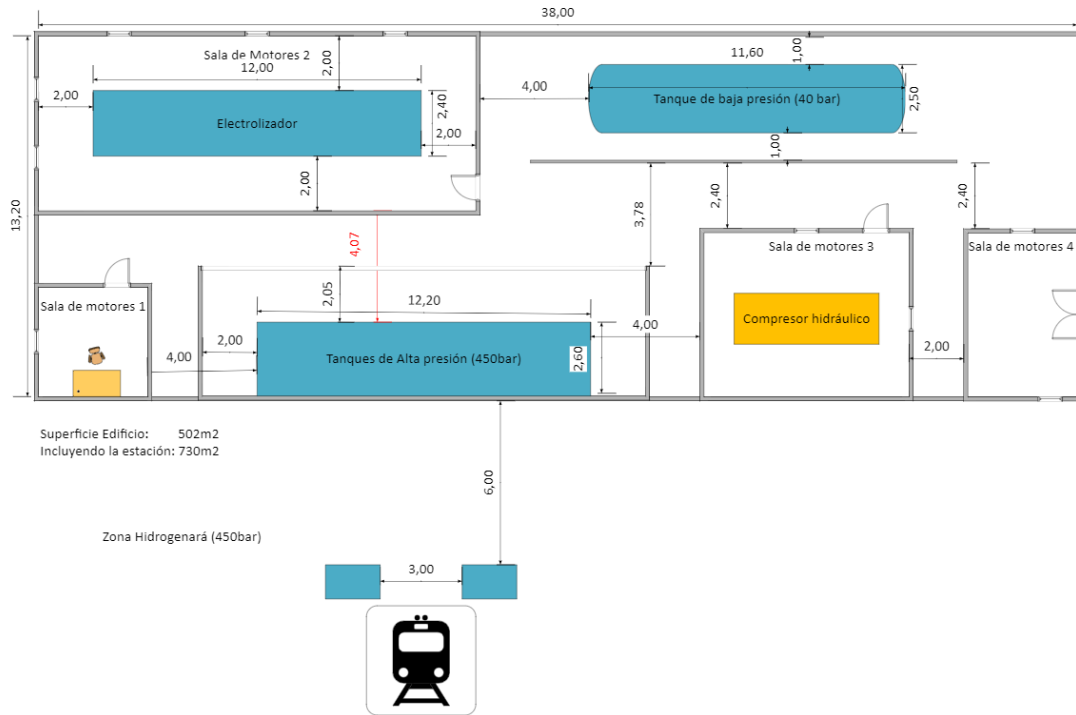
Diagrama de planta de las instalaciones alternativa baja presión
